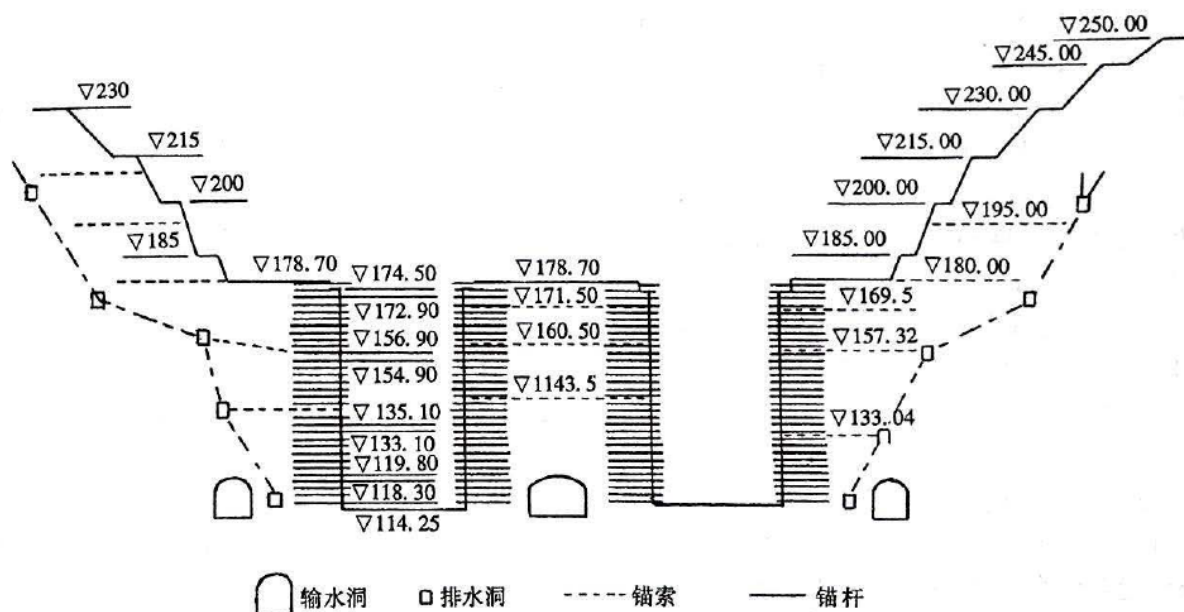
永久船闸开挖与锚固典型断面示意图(单位:m)
